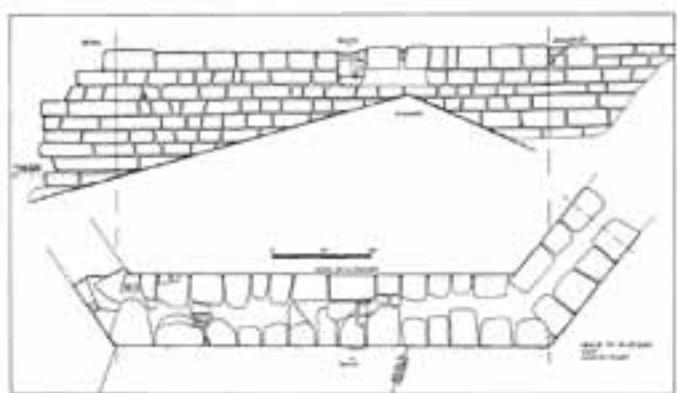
Lagrasse, élévation et plan de la butée de la chaussée (relevé JP.Sarret/JP.Caser)
